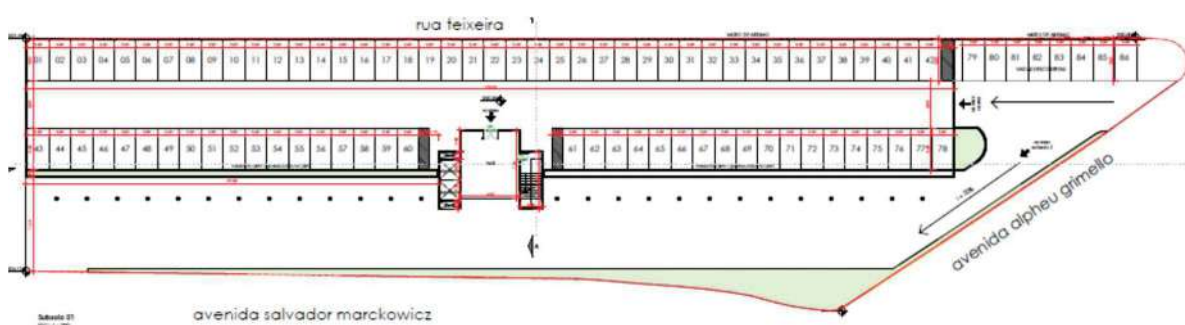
Planta do Subsolo 1, Com Vagas Internas de Estacionamento
